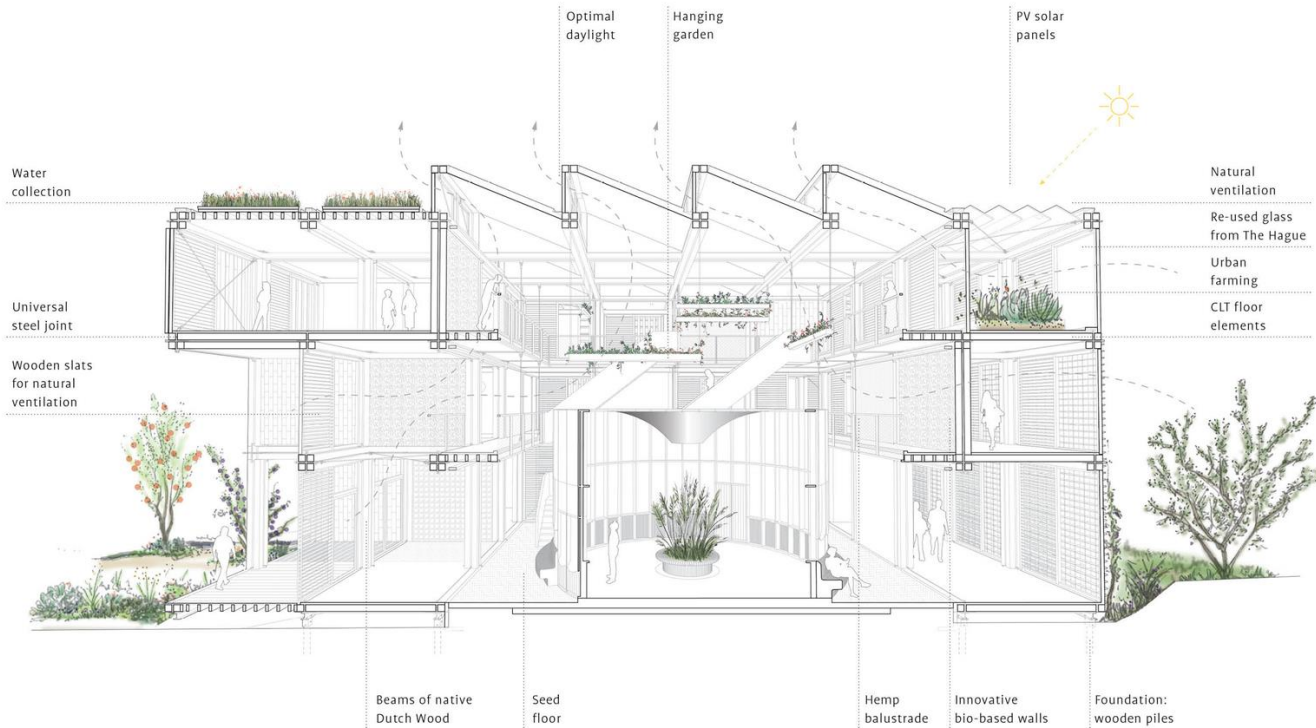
Sección transversal, DP6 Architectuur studio (Detail, Jakob Schoof, 2023).
